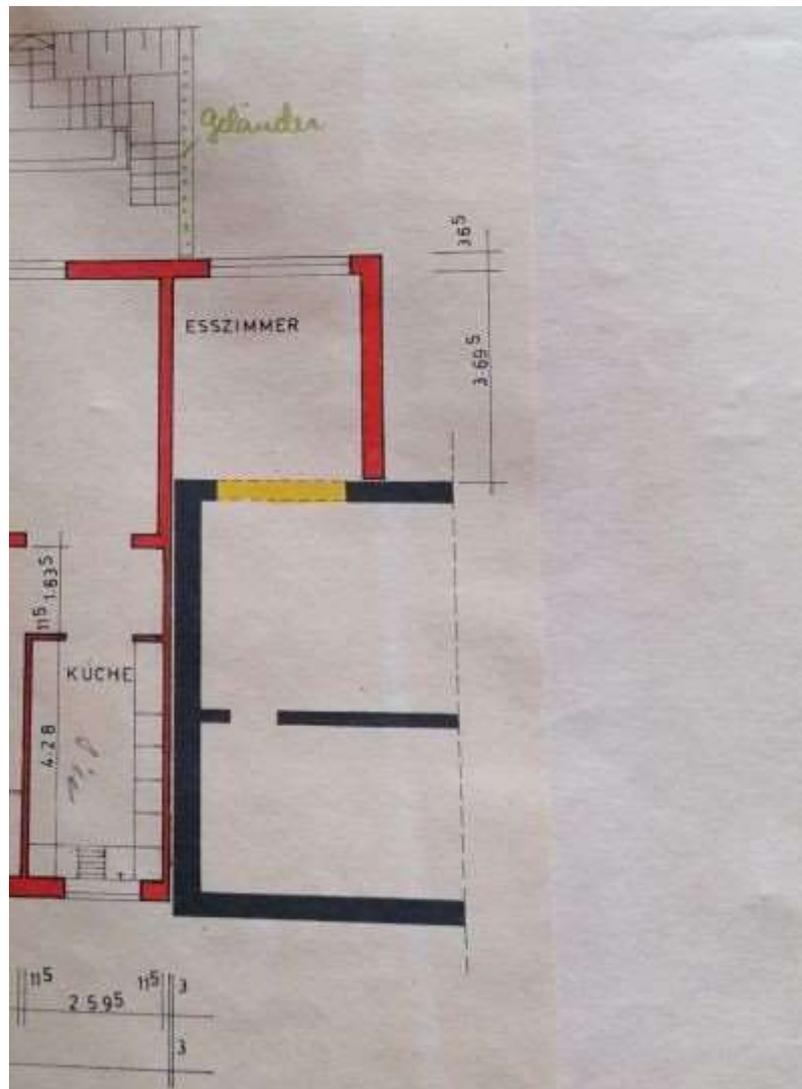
Grundriss Anbau Erdgeschoss Haus 13 Quelle: Unterlagen Antragsteller
